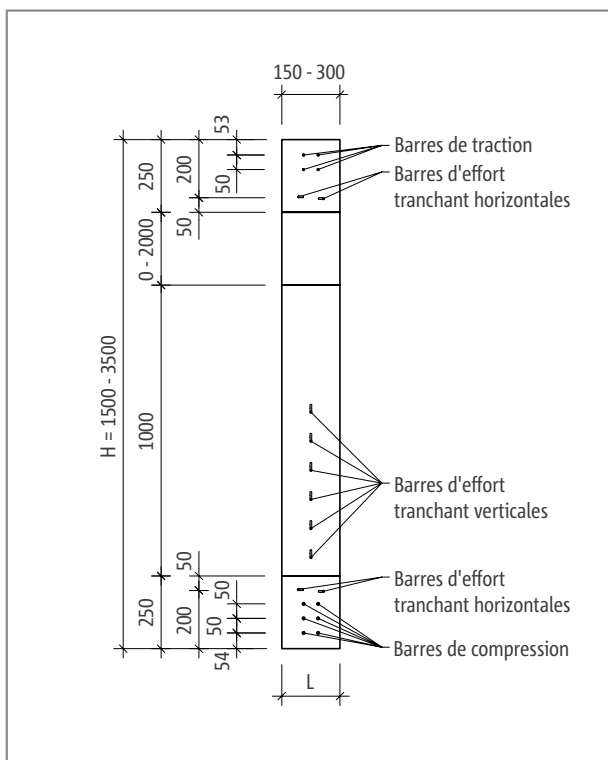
Schöck Isokorb® T Type W pour R0 : Vue du produit ; Panneaux de protection incendie sur tout le pourtour
